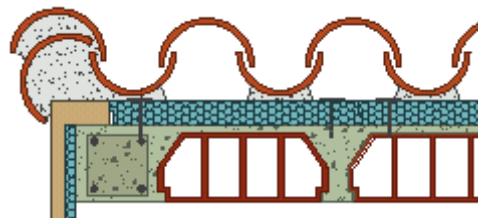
Detalle del remate lateral en cubierta inclinada.
